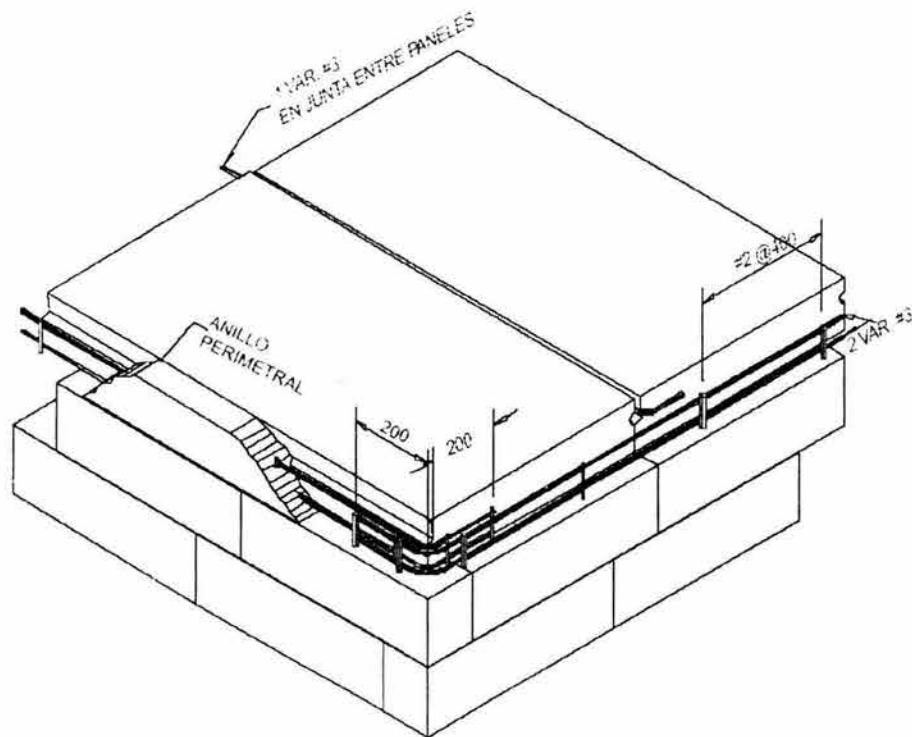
Esquema isométrico donde se muestra el detalle del armado perimetral y de las juntas longitudinales en los paneles.
